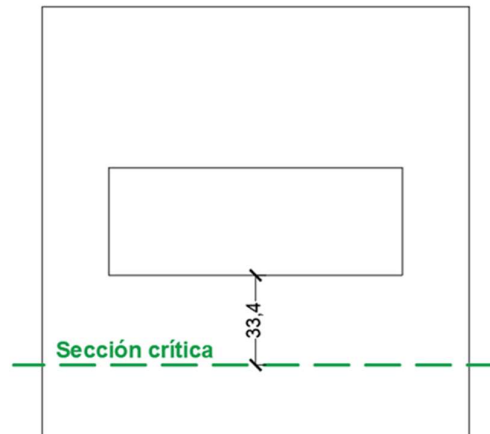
| Sección crítica de la zapata a corte en una dirección. Fuente: Elaboración propia.
